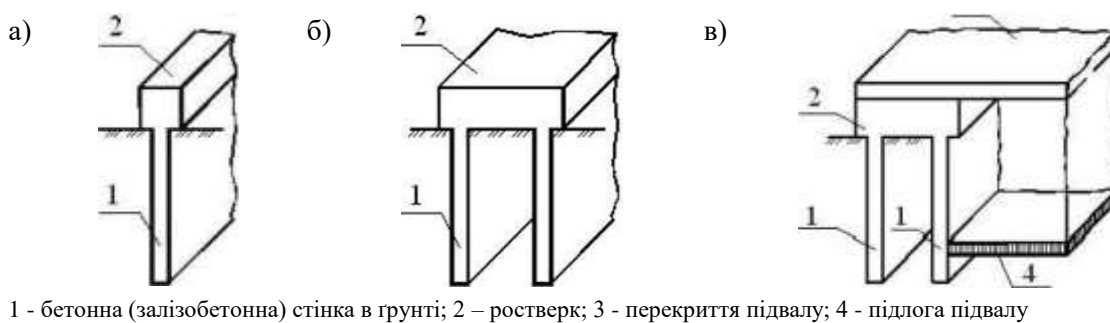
Щілинний фундамент у безпідвальної будівлі (а, б) та в будівлі з підвалом (в)
